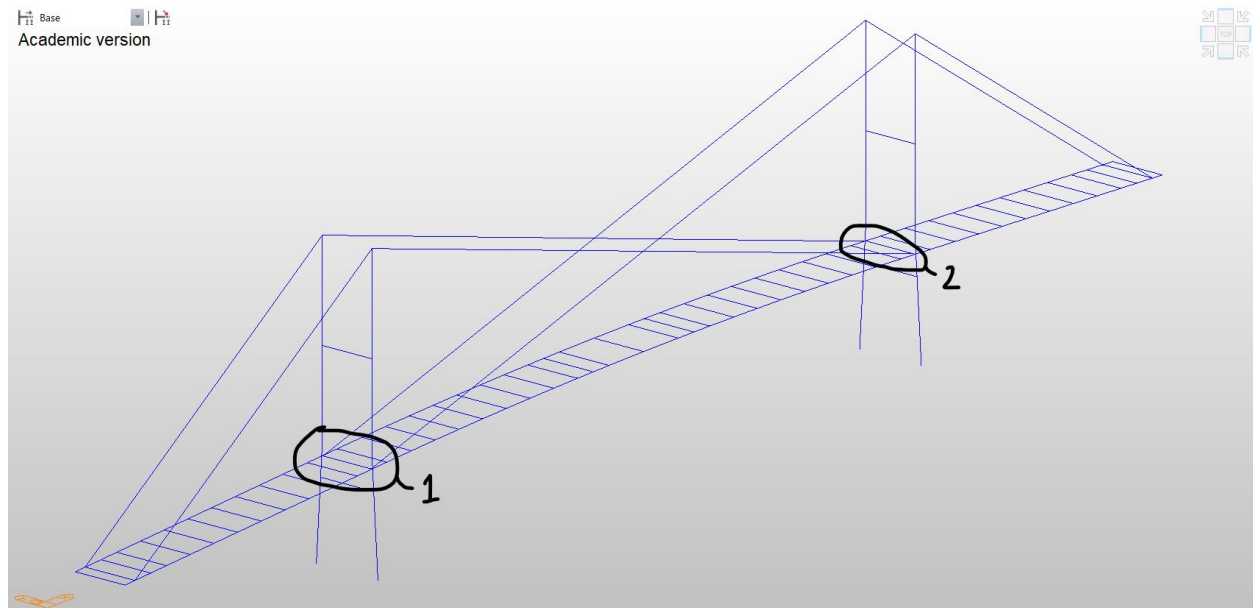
Geometría sistema de rigidización longitudinal 2 en estructuras atirantadas según 2 planos
